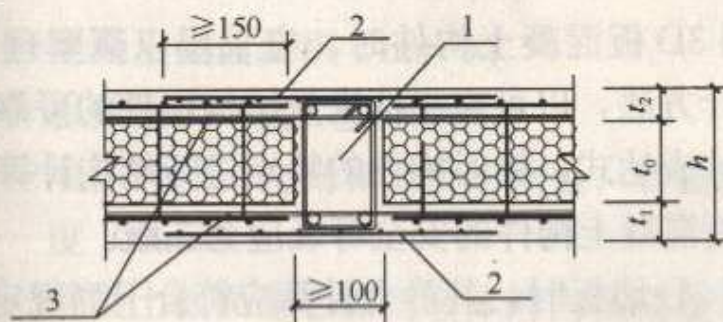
3D 楼板（屋面板）间增加钢筋混凝土小梁或肋的构造
